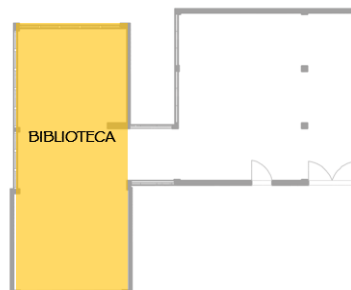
Planta Técnica Biblioteca– IFMG Santa Luzia
